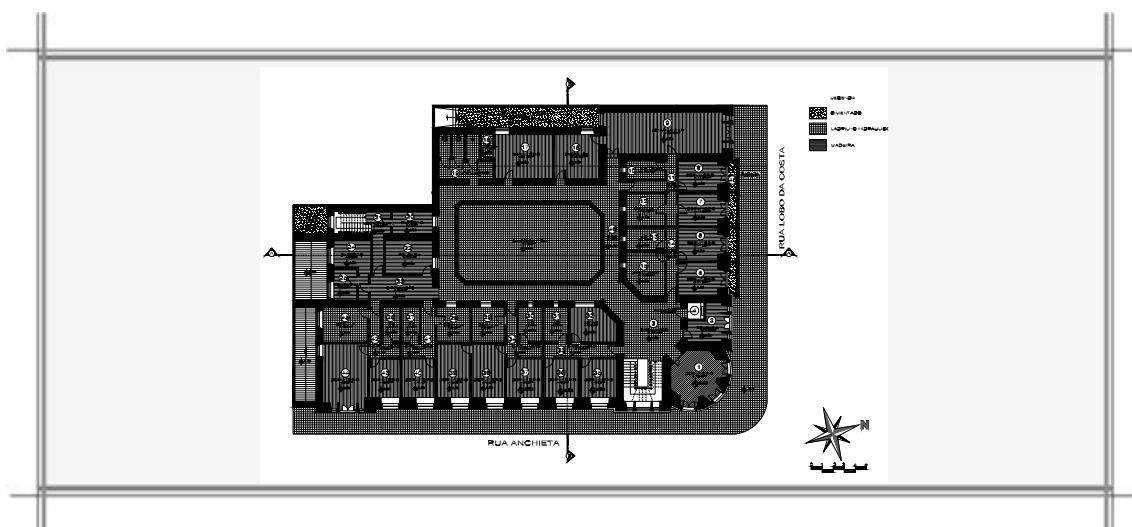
Planta Baixa do 2º Pavimento. Desenho: Cristiane Müller.
